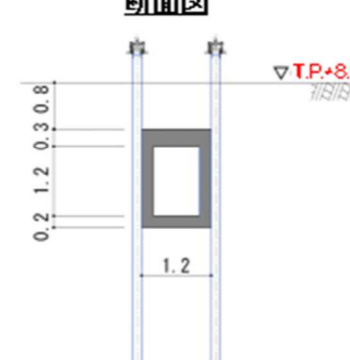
【3-1】排水ヒューム管① 施工方法 (複列施工)
